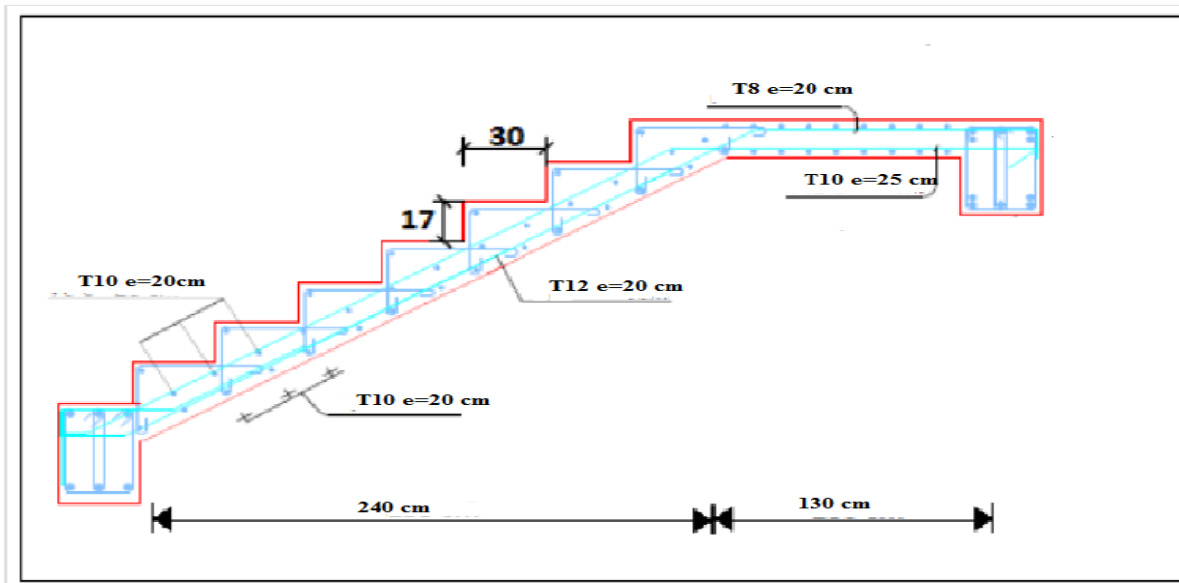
Schéma de ferrailages d'escaliers types 2
